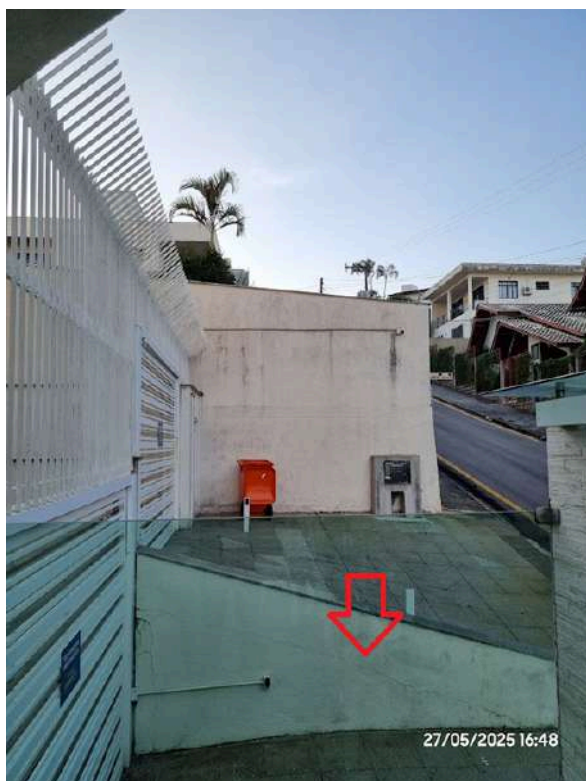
e 054 - Fissuras/trincas/rachaduras em muro do ambiente área de lazer descoberta
